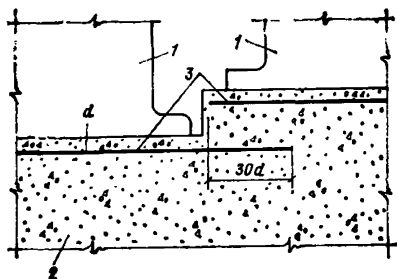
Армирование массивного фундамента при близком расположении станин оборудования
